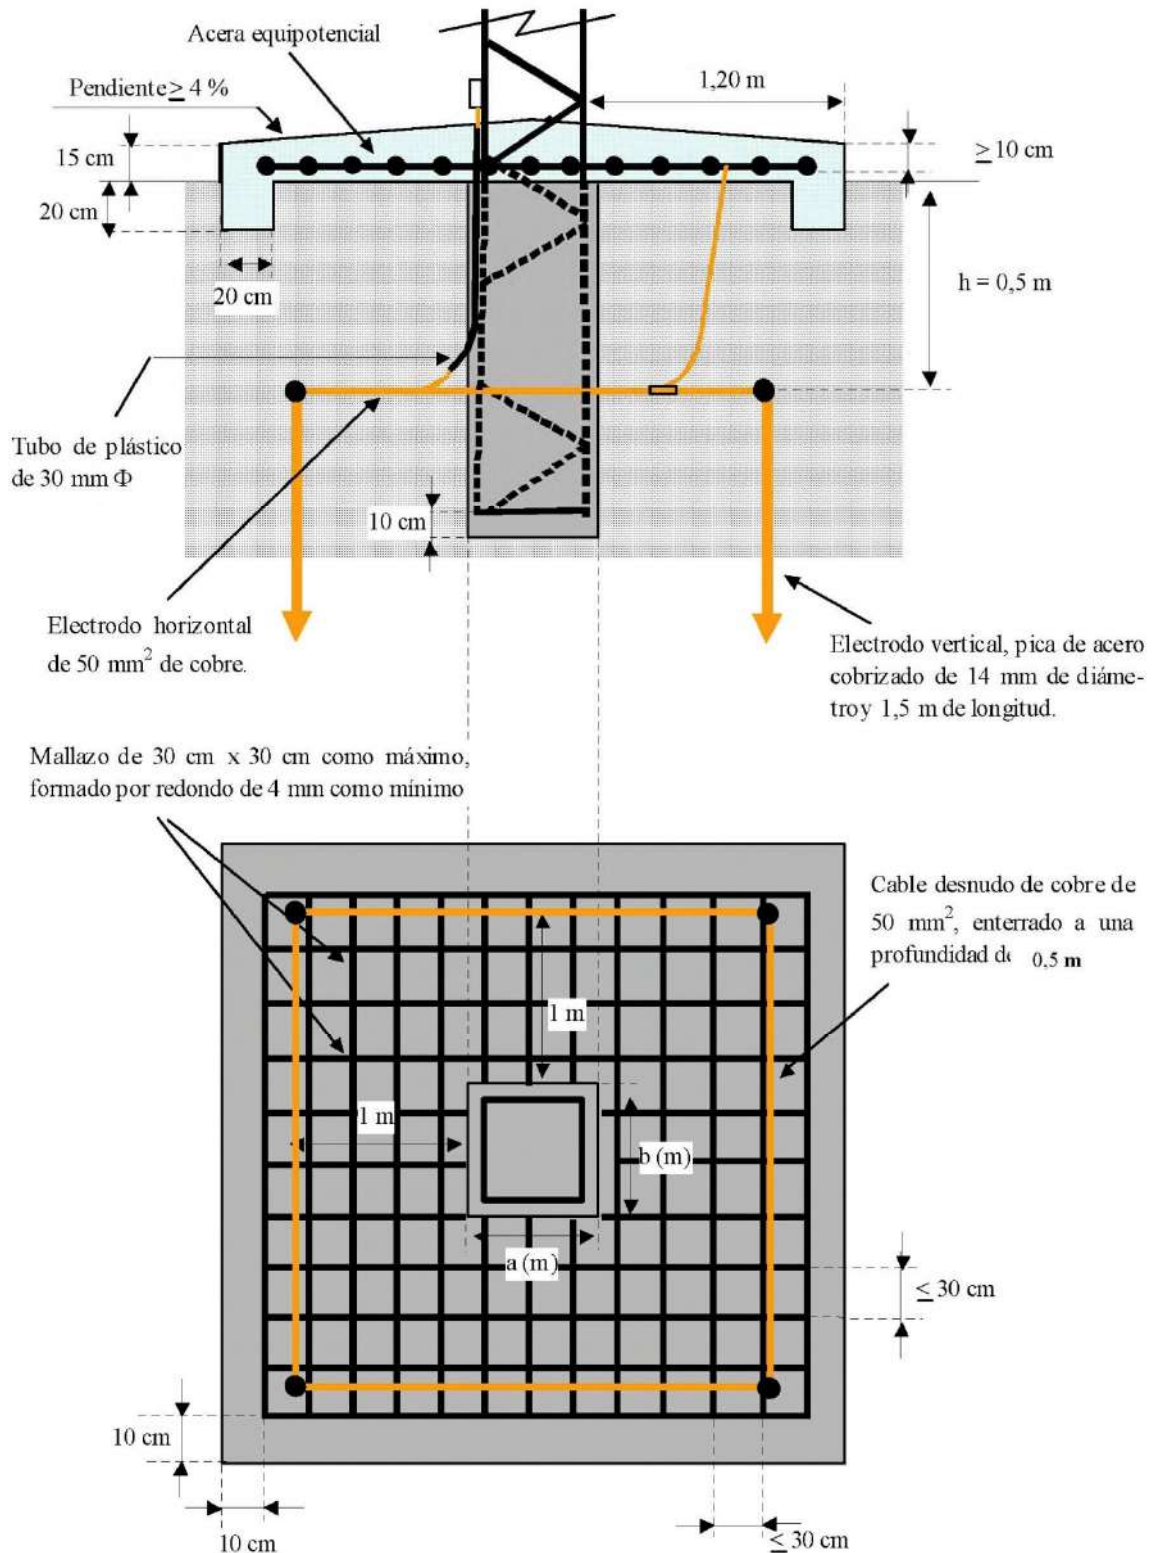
Acera de hormigón, con mallazo equipotencial, perimetral con la cimentación del apoyo y configuración del electrodo de puesta a tierra empleado en líneas aéreas con apoyos frecuentes con calzado.
